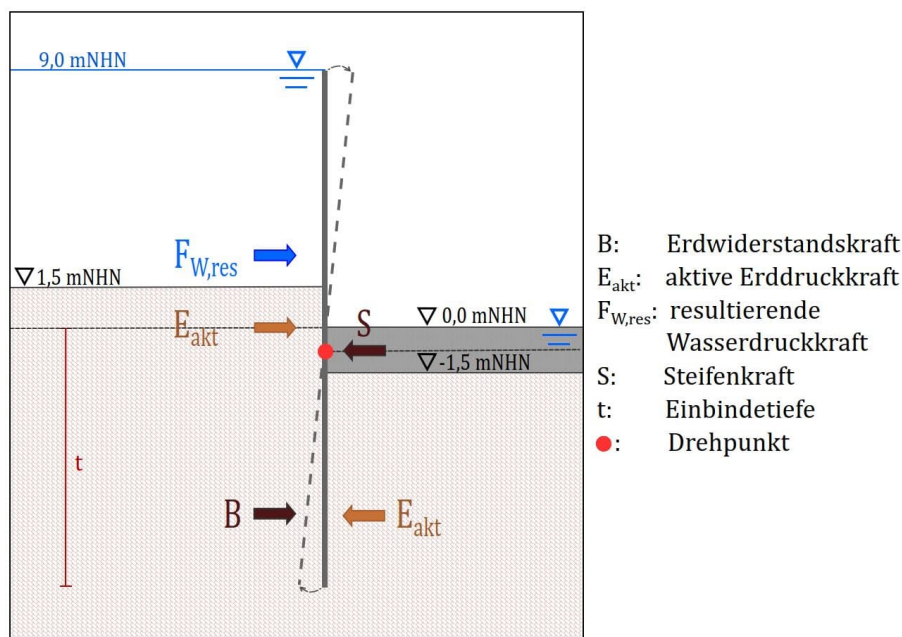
Statisches Modell für Baugrubenwand mit Unterwasserbetonsohle
